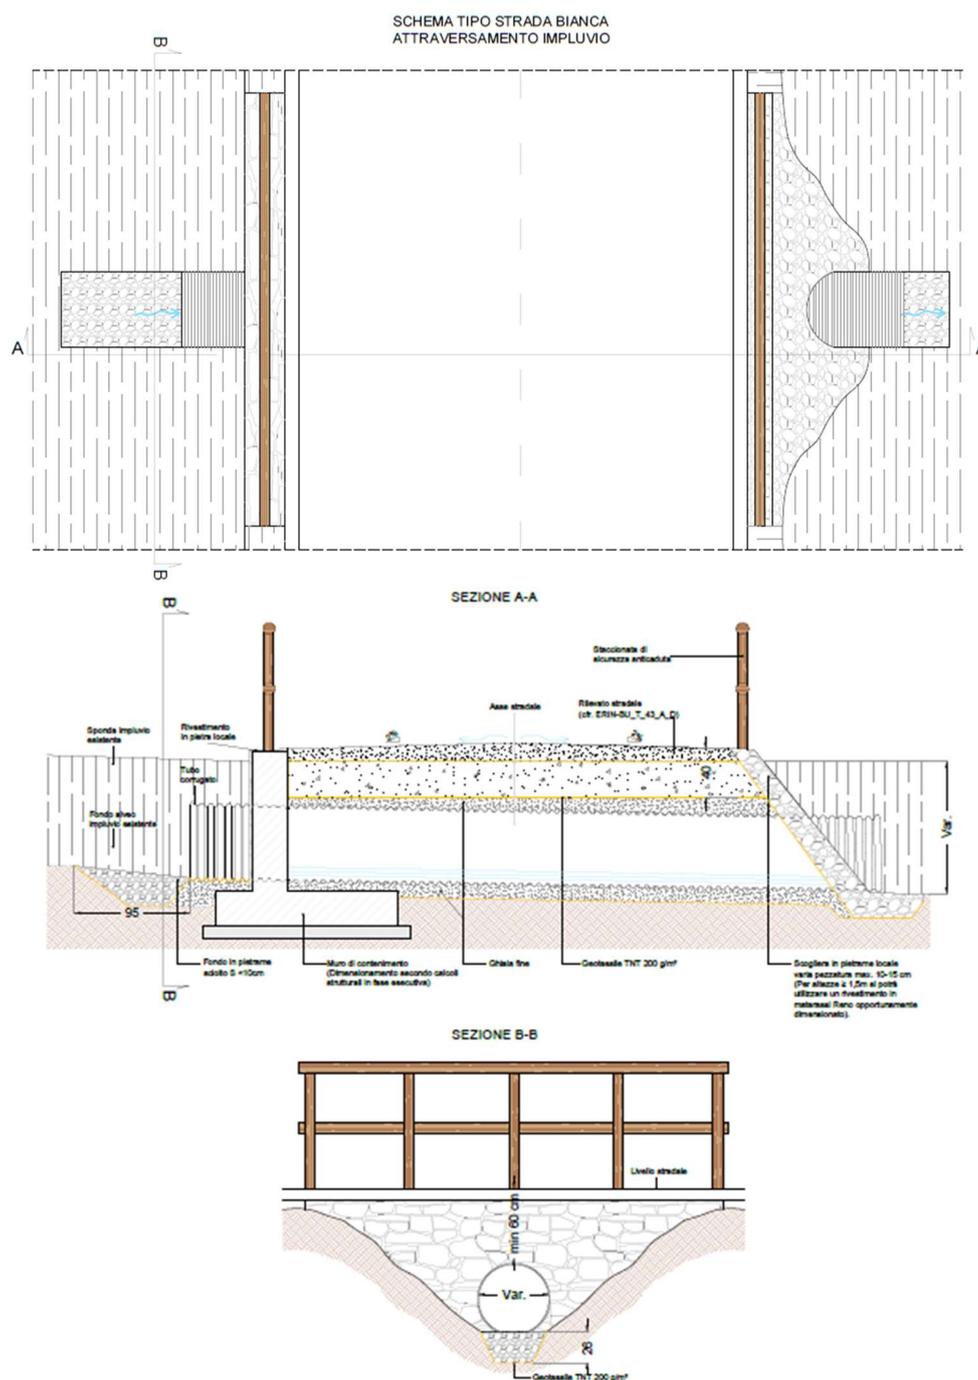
Sezioni tipo dell'attraversamento stradale di un impluvio – tutte le misure in cm
